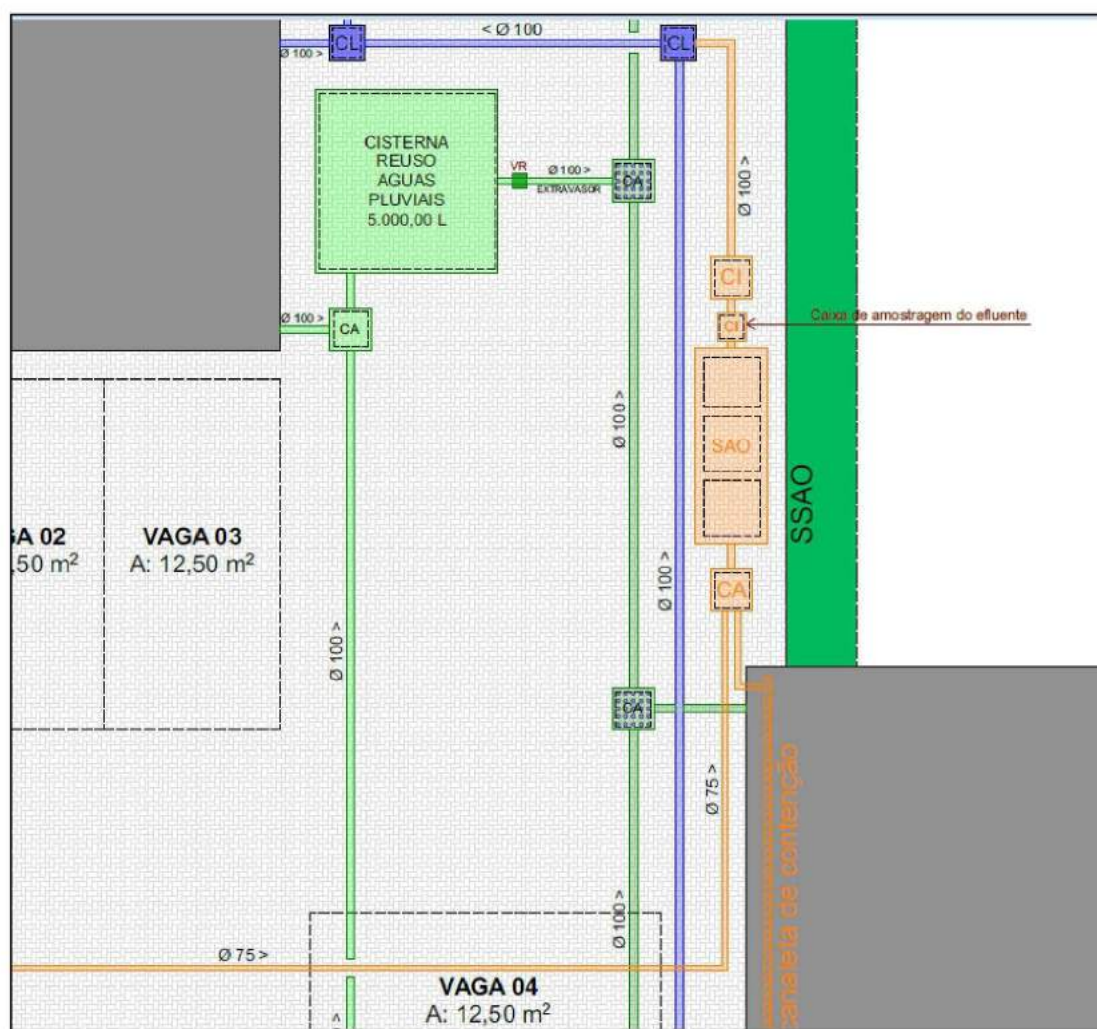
Localização do SSAO. Fonte Projeto Hidrossanitário.
